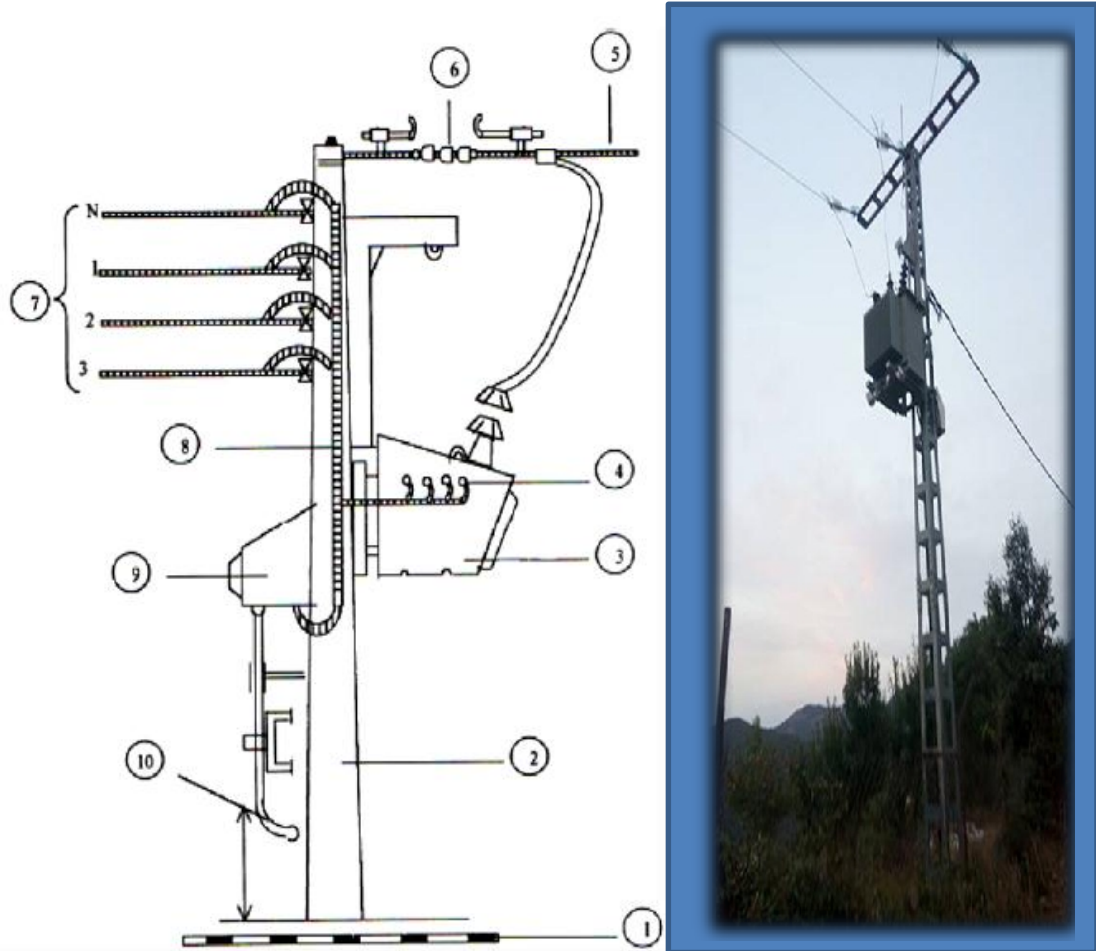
poste de transformation aérien sur poteau (ACC).
